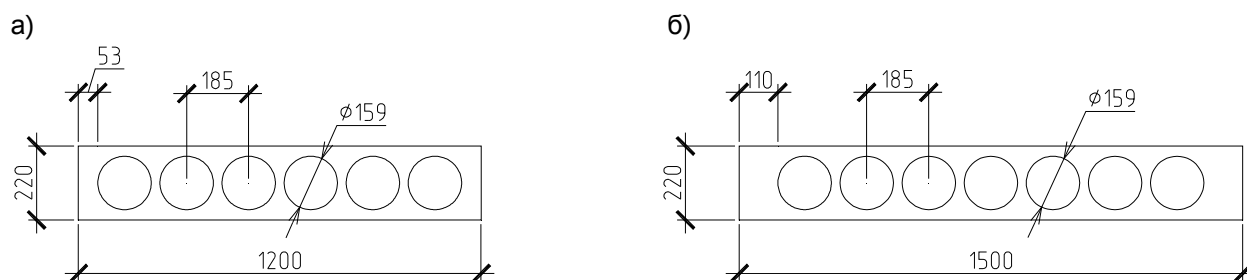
Поперечний переріз круглопустотних плит шириною 1,2 і 1,5 м.
